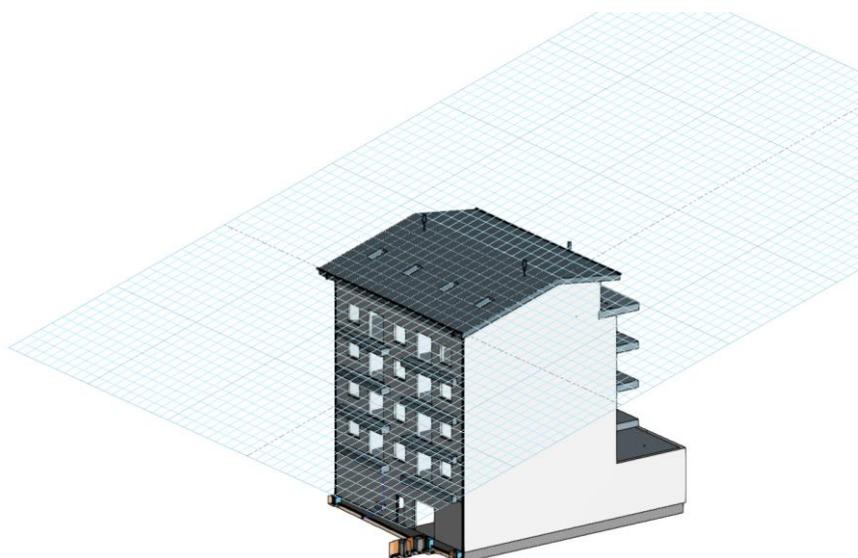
Plano de trabajo generado a partir de un plano genérico.
